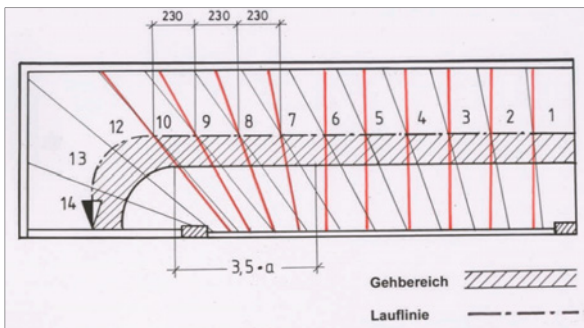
Grundriss aus Bild 3 nach der Neuregelung angepasst
